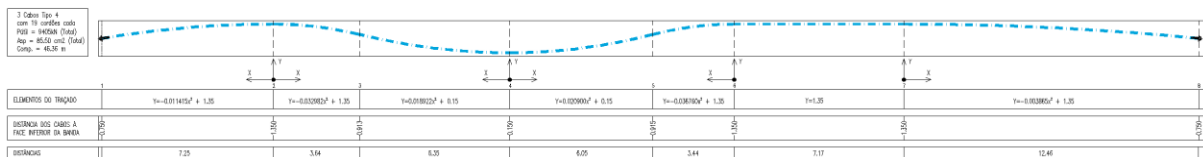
Traçado de cabos da viga longitudinal BM1.4 no piso 1 – Eixo HA.C.
